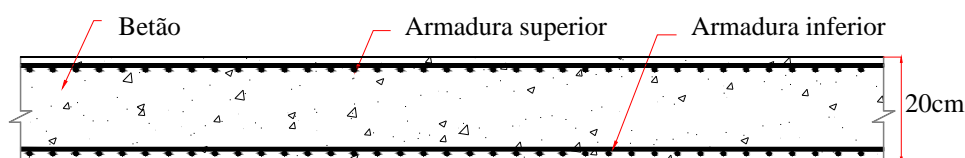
Pavimento de estrutura contínua em laje maciça de betão armado sem isolante (Pav4)
